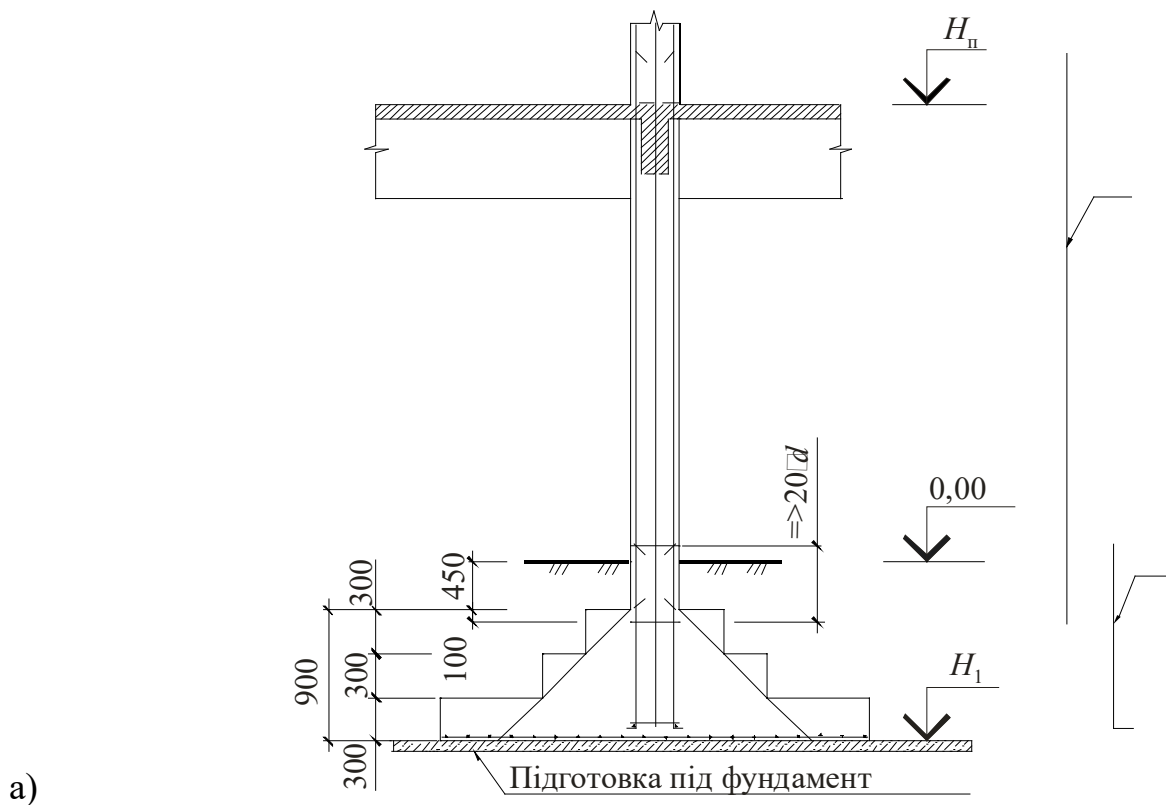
Варіанти компоновки поперечного перерізу колони
